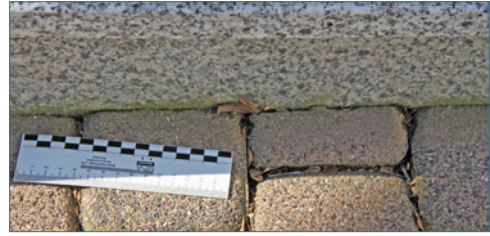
Materialabtrag an Betonpflastersteinen einer Pflasterdecke durch die Reinigung mit einem Hochdruckreiniger
